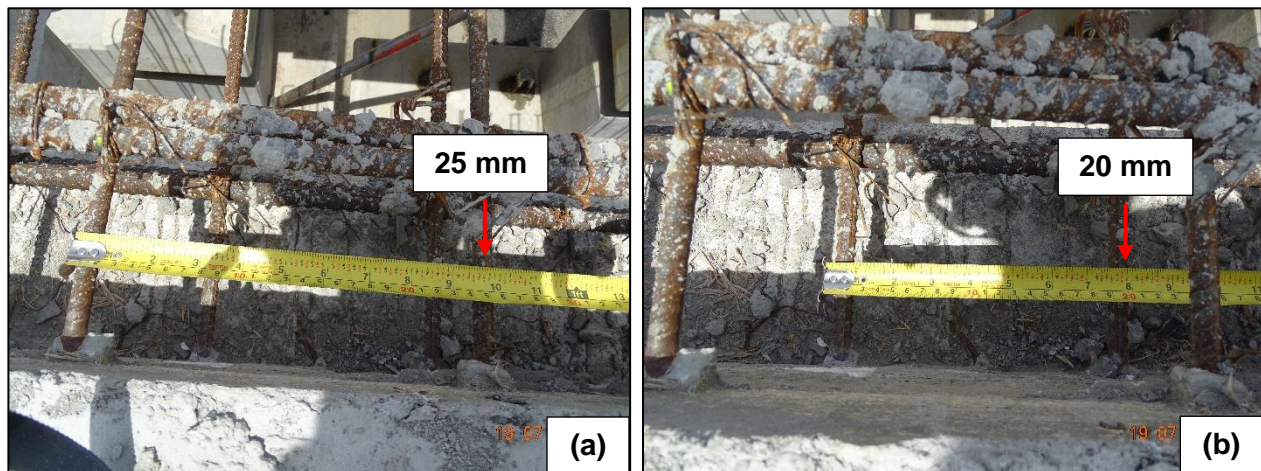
Detalle del acero de refuerzo de la prelasas prefabricadas como se muestra en los planos estructurales del proyecto.
